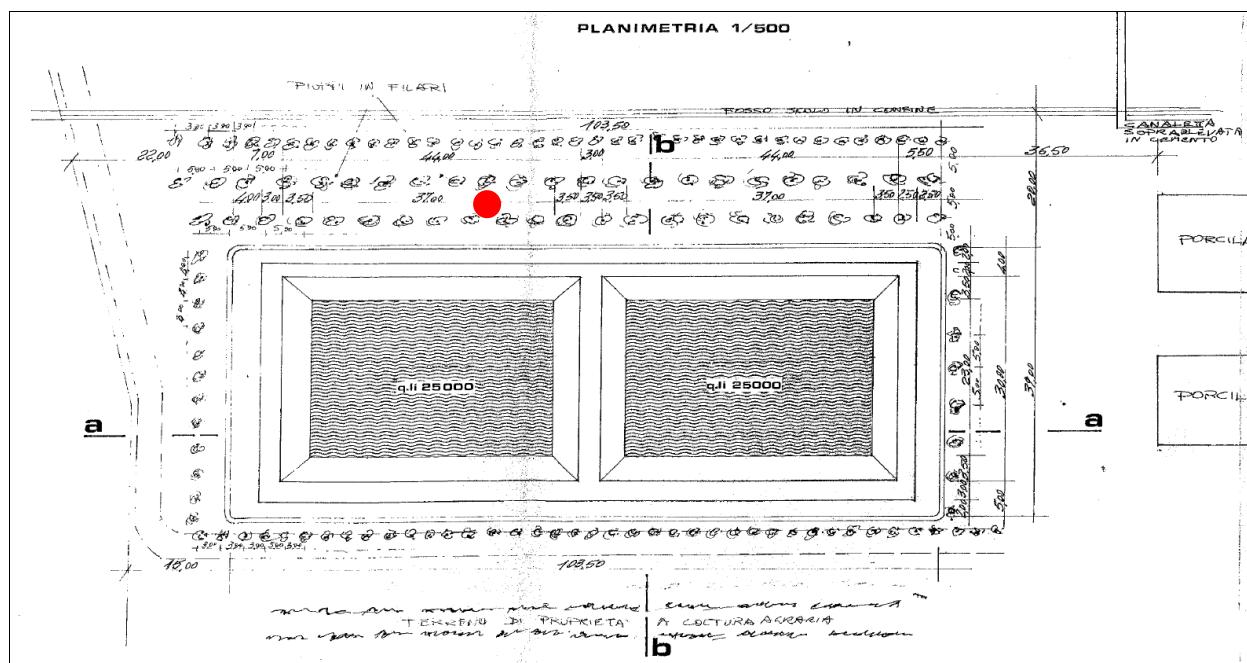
Estratto della planimetria di progetto presentata per l'autorizzazione nel 1995.
